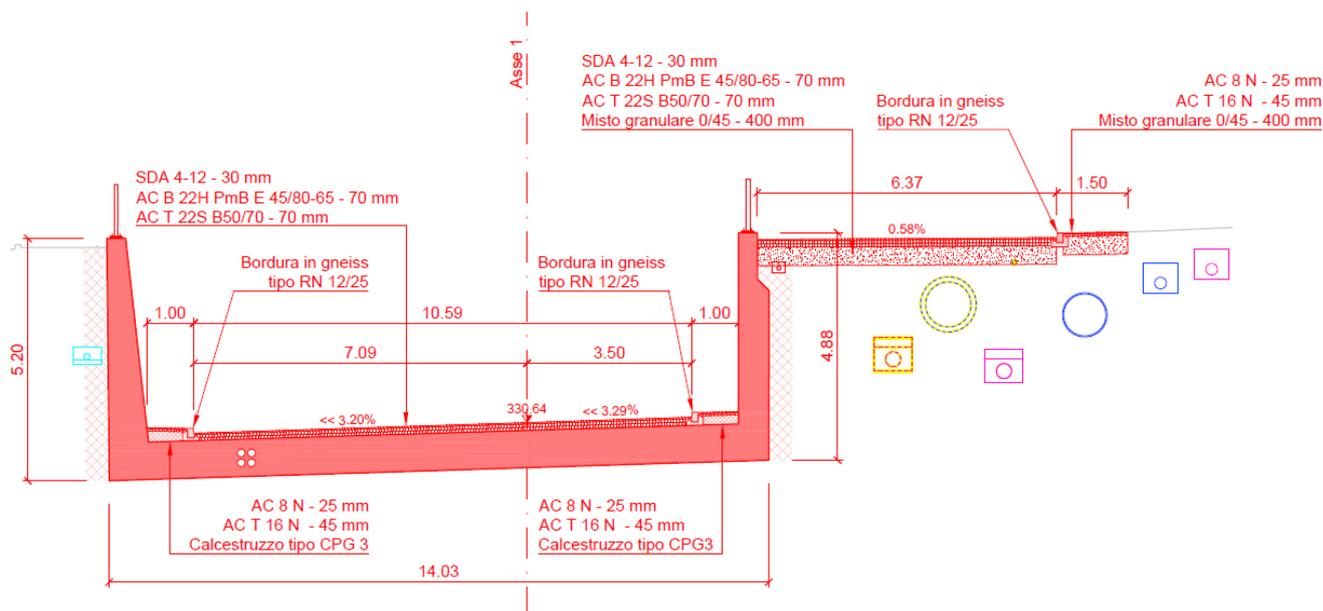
Sezione trasversale tratta Est e Rampa laterale Est
